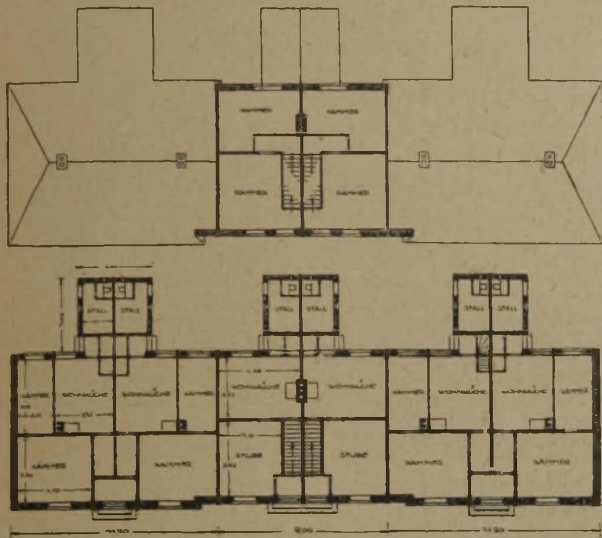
Haustypen im Grundriß. Maßstab 1:400.
